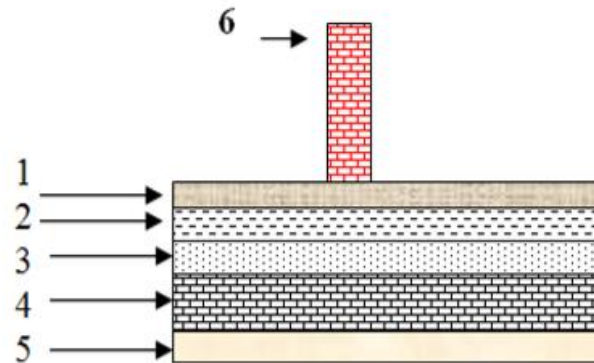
Coupe verticale d'un plancher des étages courant.
